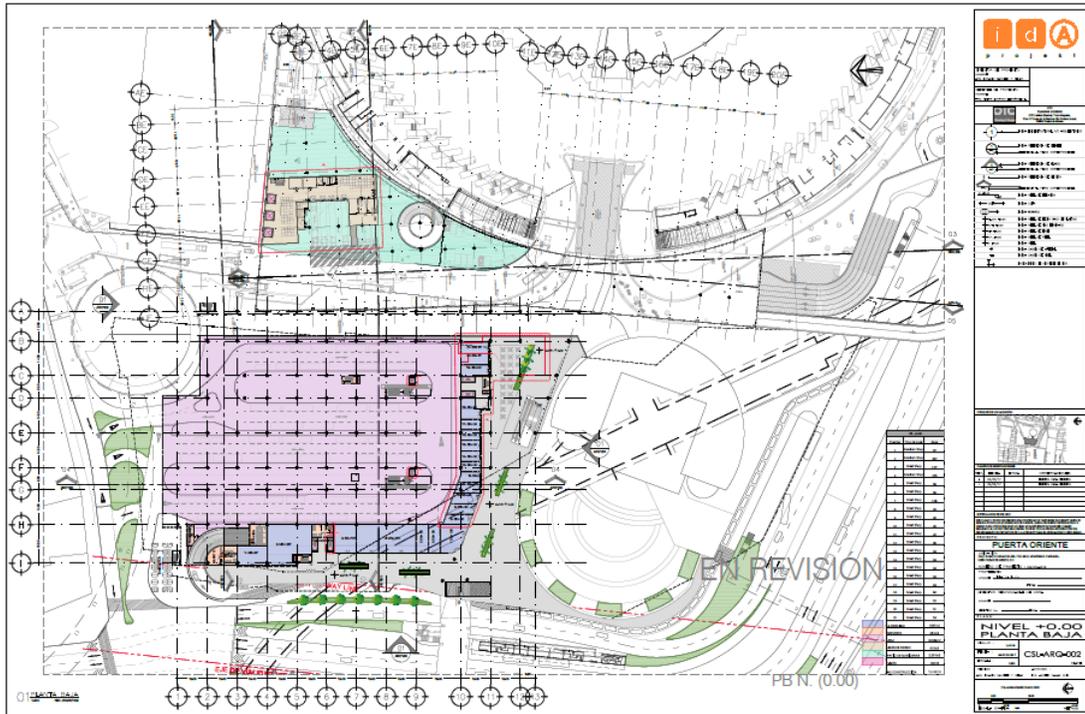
Nivel Planta Baja. Fuente: Puerta Oriente por IDA Projekt.
